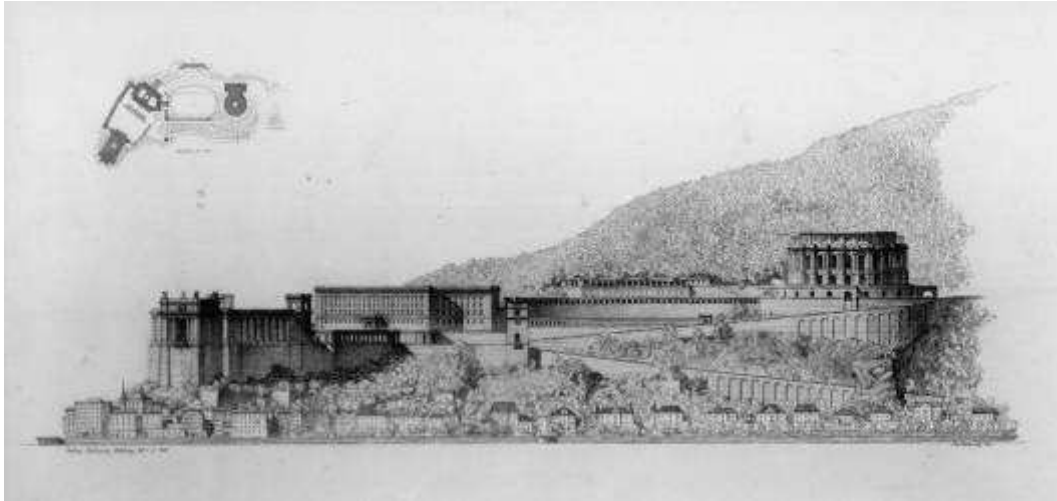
Otto Strohmayer, Ansicht mit Lageplan links oben, Imbergverbauung, Salzburg, 1942 (HSS, INR 004.564).
